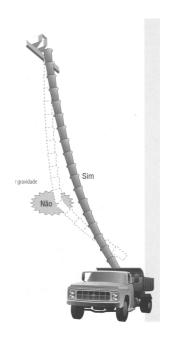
Disposição de elementos plásticos na remoção por gravidade
